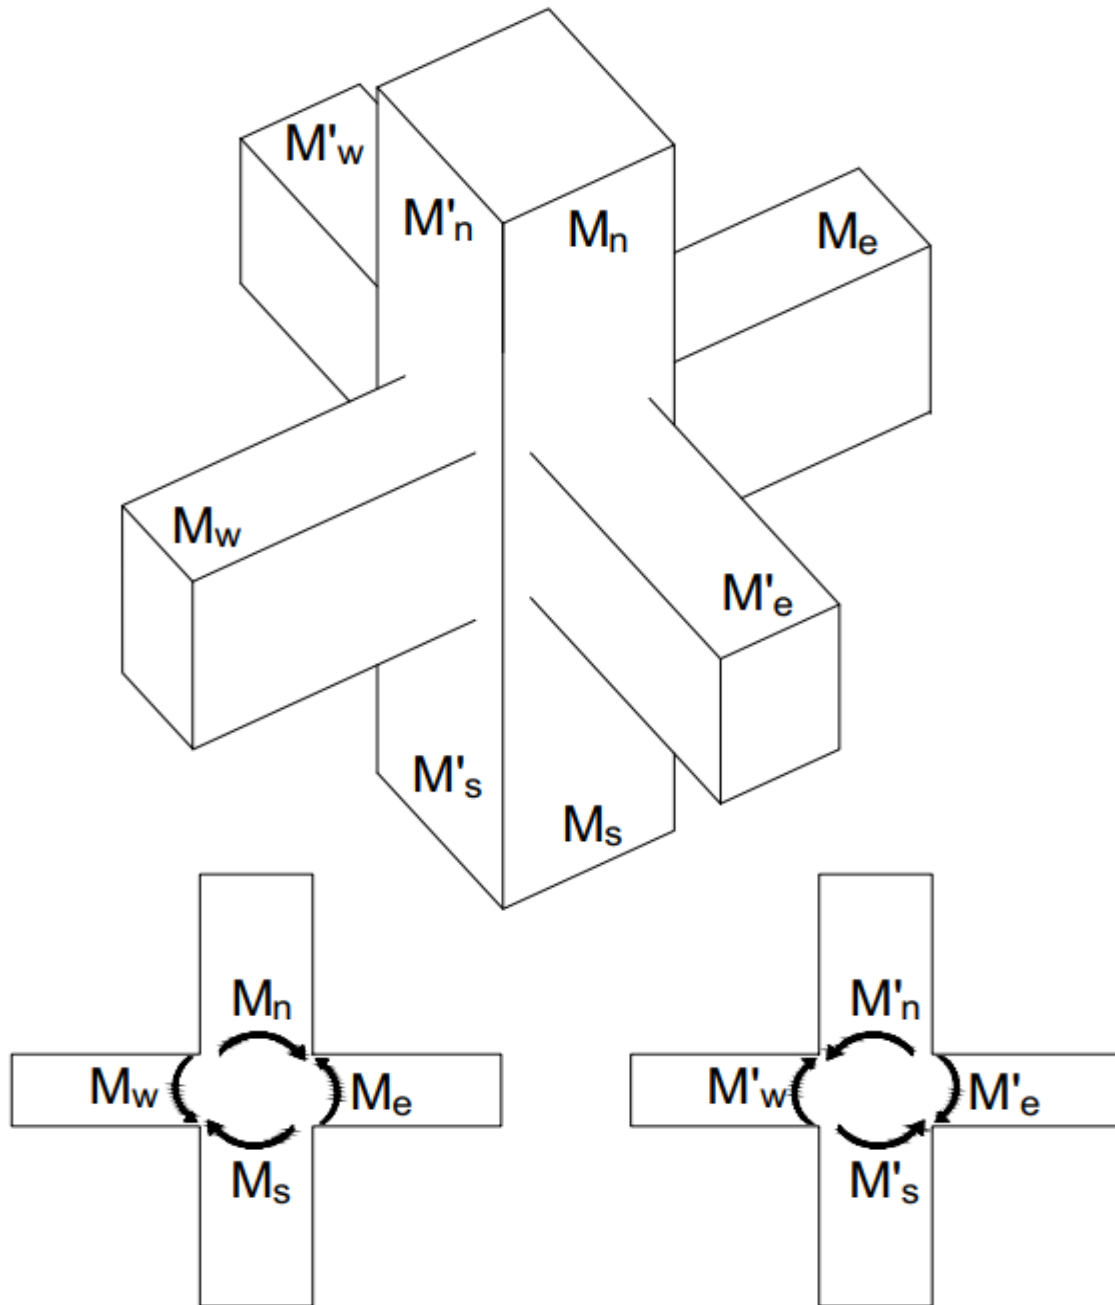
Dimensionnement d'un nœud poutre-poteau
